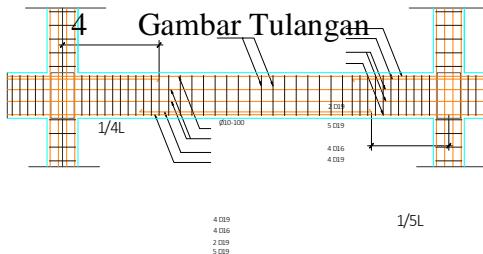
Detail tulangan balok 35 x 70 ( lantai 5 )
